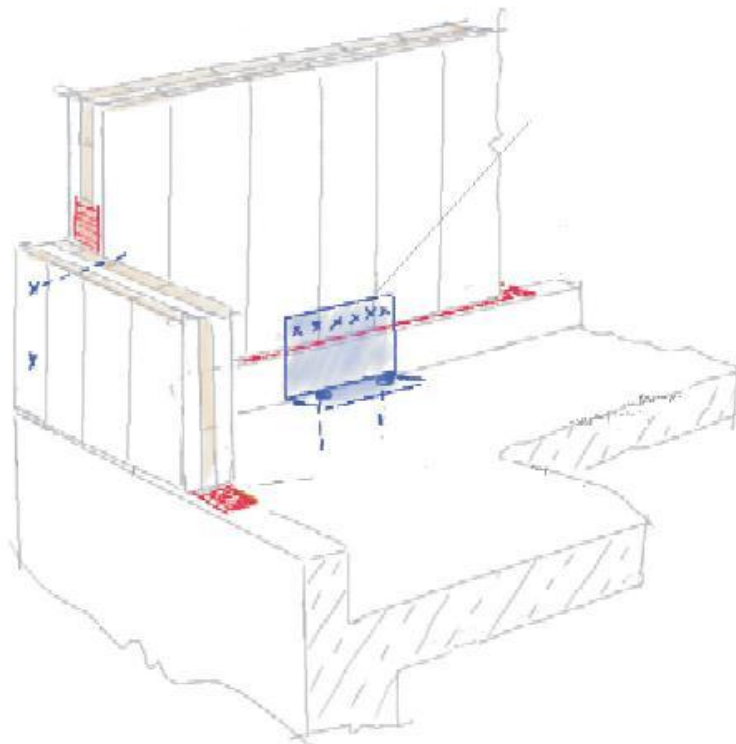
Ligações horizontais e verticais por ligadores metálicos [22]
